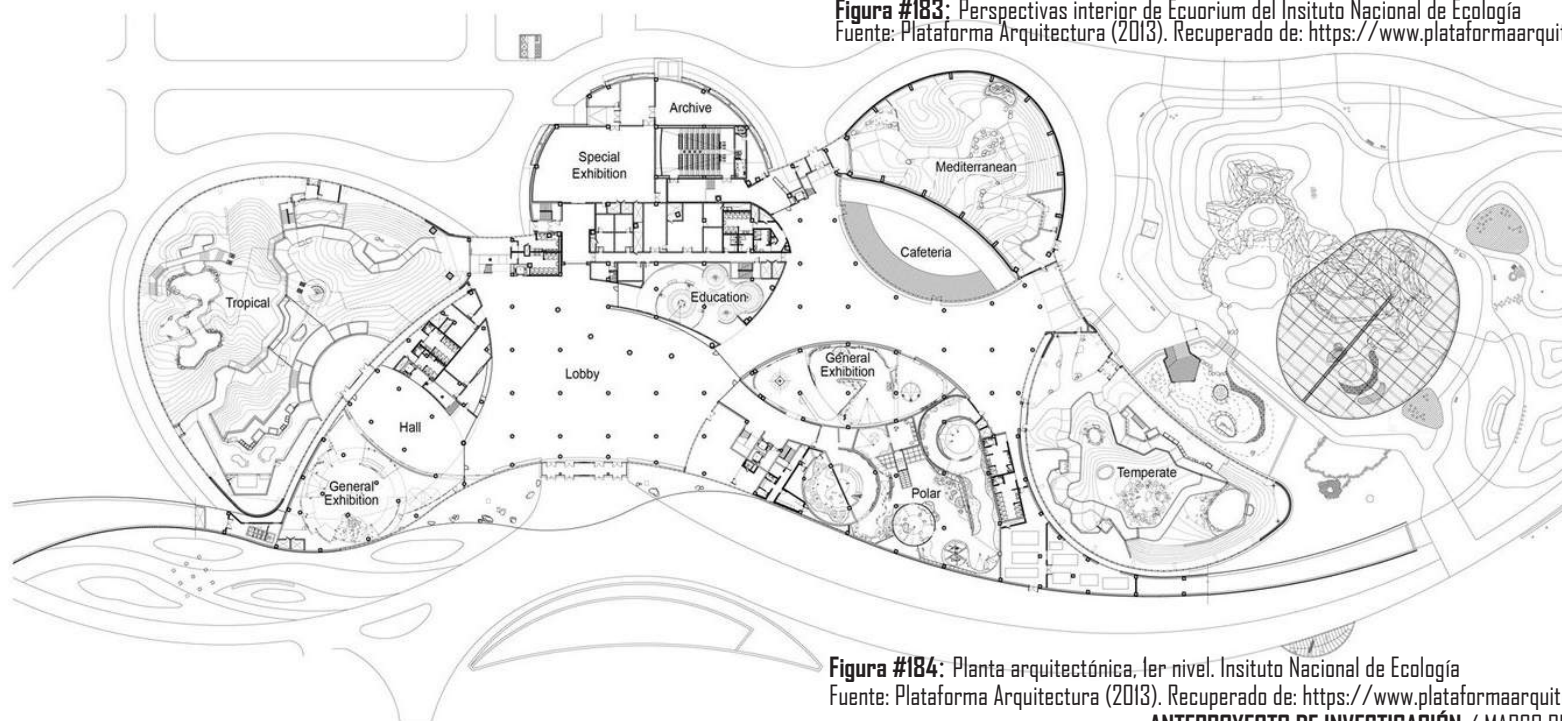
Planta arquitectónica, 1er nivel. Insituto Nacional de Ecología
